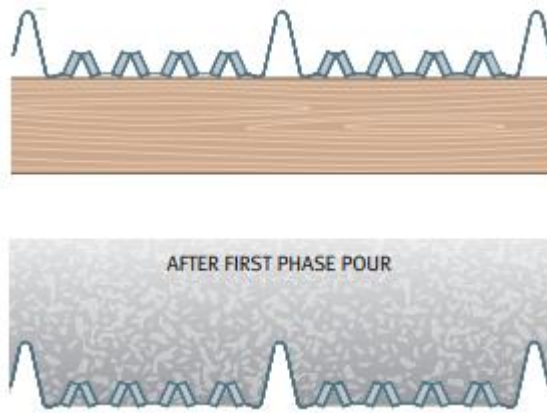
Forma de colocar el moldaje Hy - rib.
